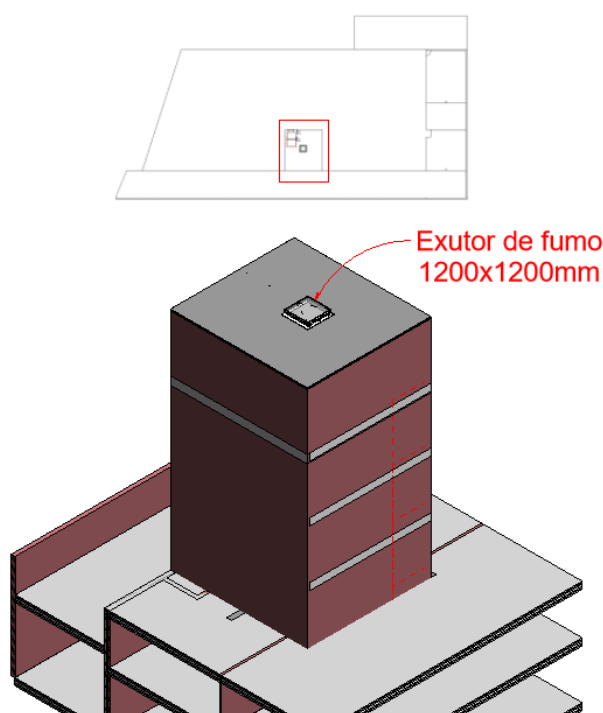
Vista 3D - Pormenor Exutor de Fumo
